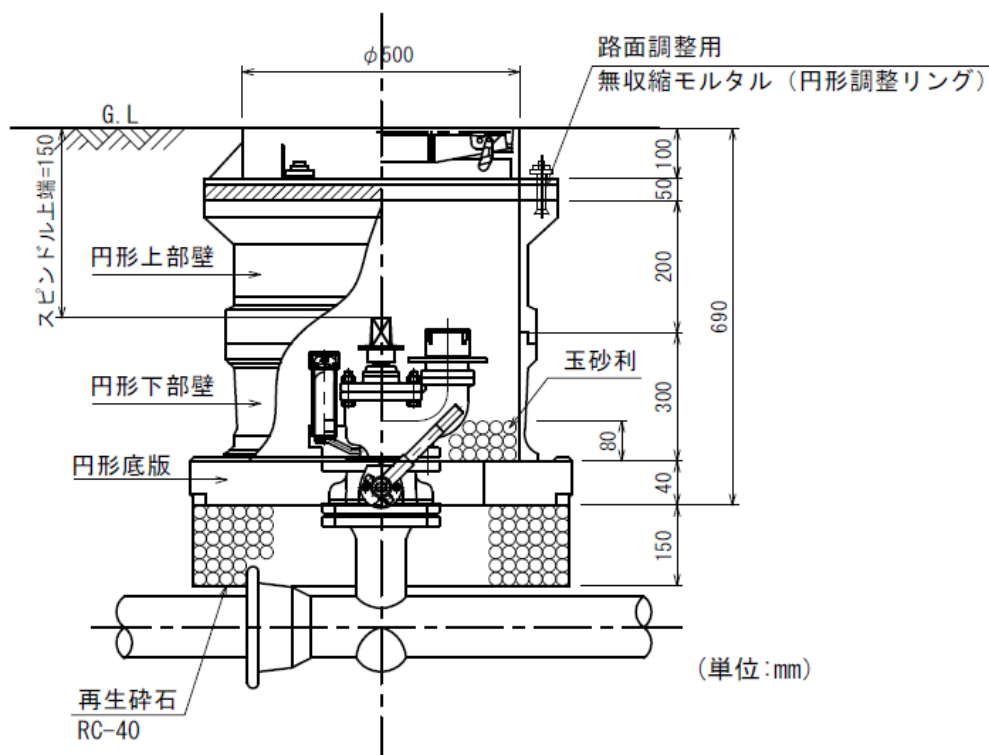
地下式単口消火栓断面図 (丸蓋の場合) (単位 mm)
